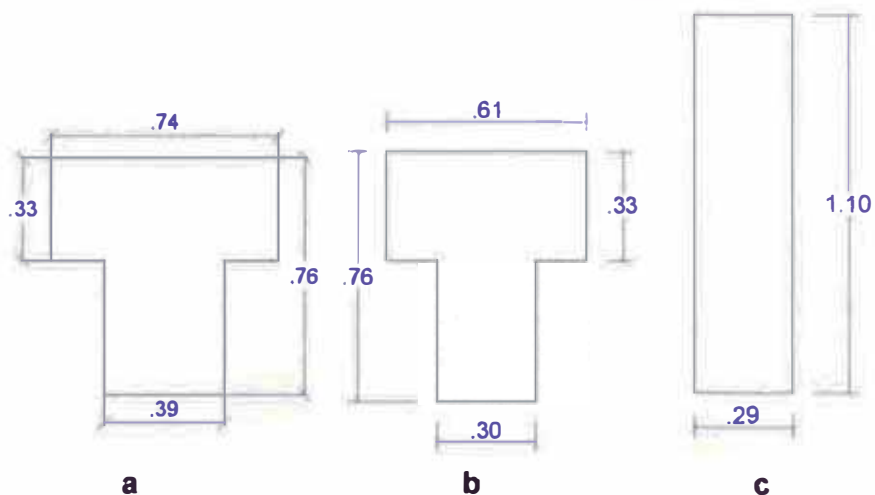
(a) Sección de las vigas principales a lo largo del eje transversal, (b) Sección de las vigas longitudinales interiores y (c) Sección de las vigas longitudinales laterales.
